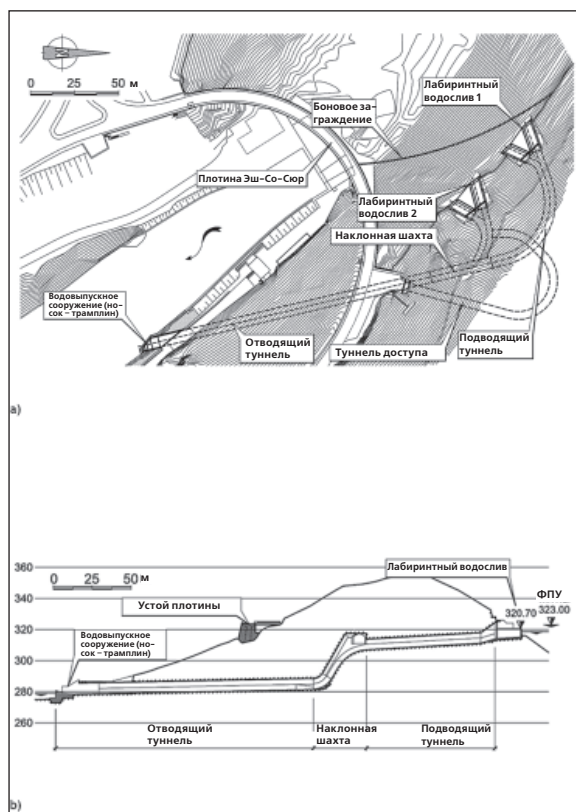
Генеральный план и продольный разрез нового водосброса на дамбе Эш-Со-Сюр
